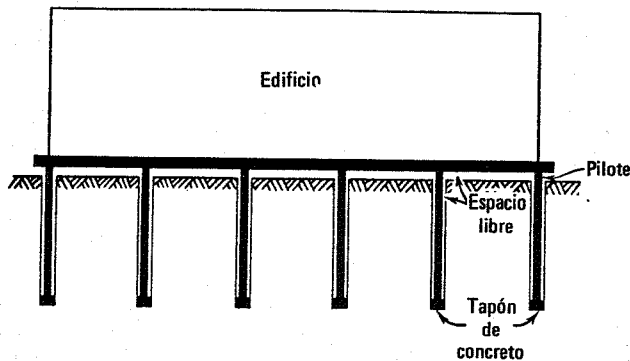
Edificio cimentado en un terreno expansivo.
